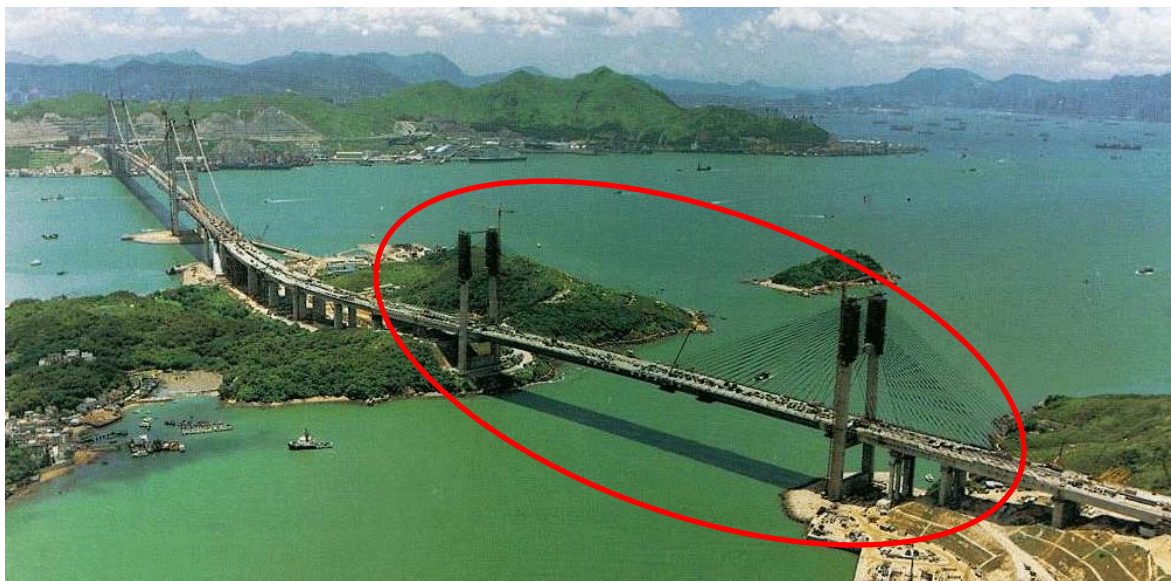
Construção da ponte Kap Shui Mun na ligação Lantau, China [73]
